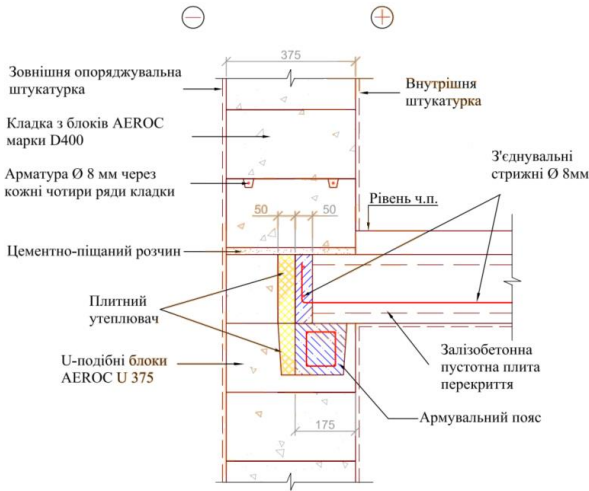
Обпирання панелі перекриття на монолітний армувальний пояс [4]
